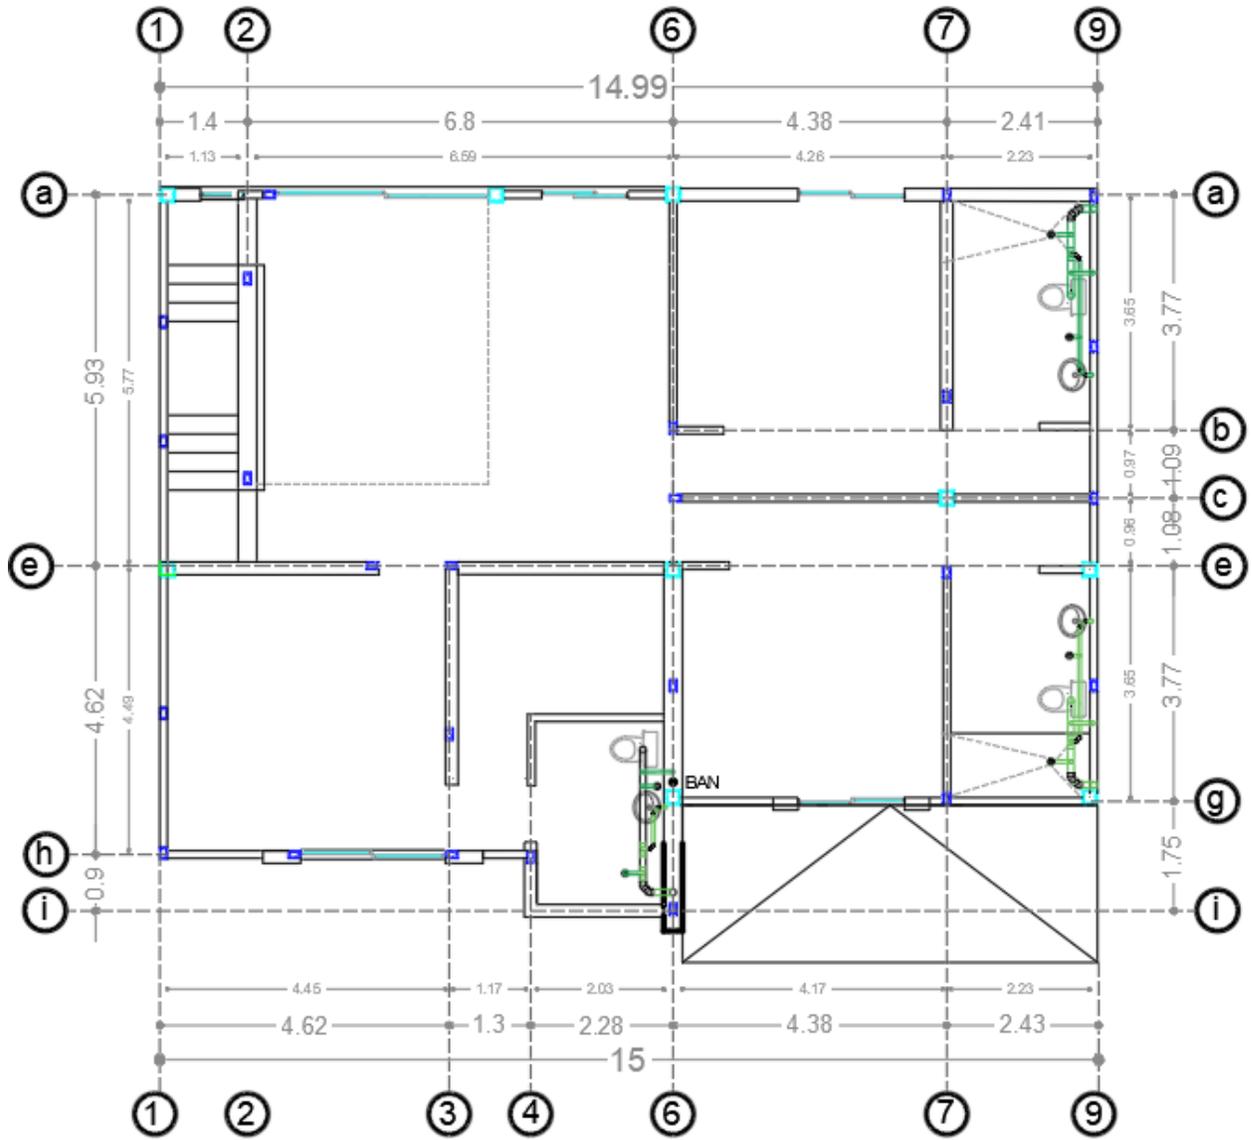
Plano sanitario planta alta (Muciño, 2022)
